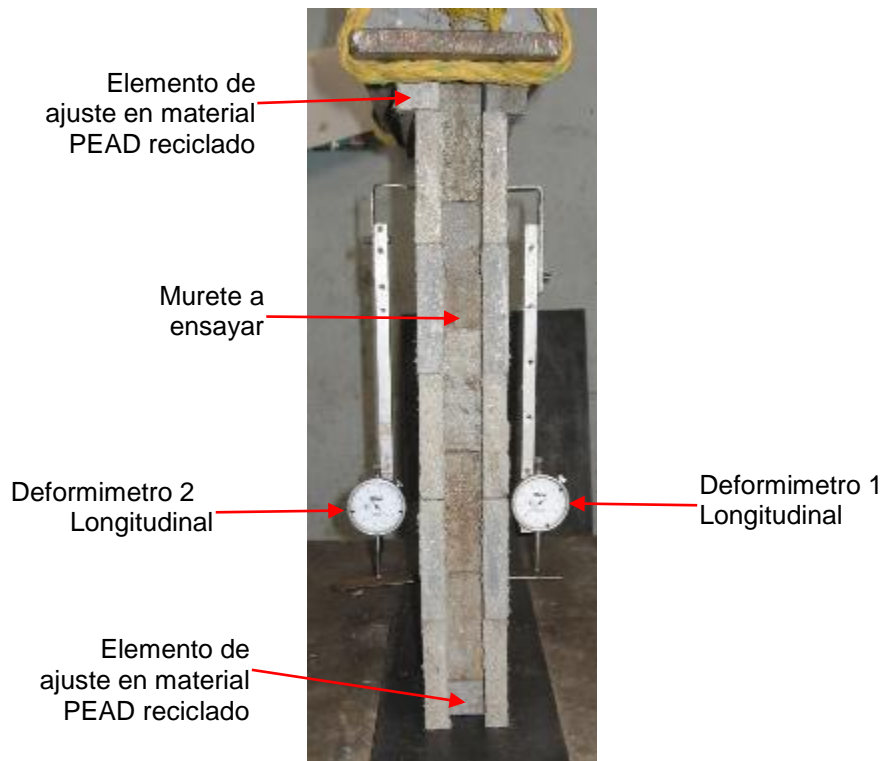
Montaje ensayo de compresión en muretes vista perfil. Fuente: Autor
